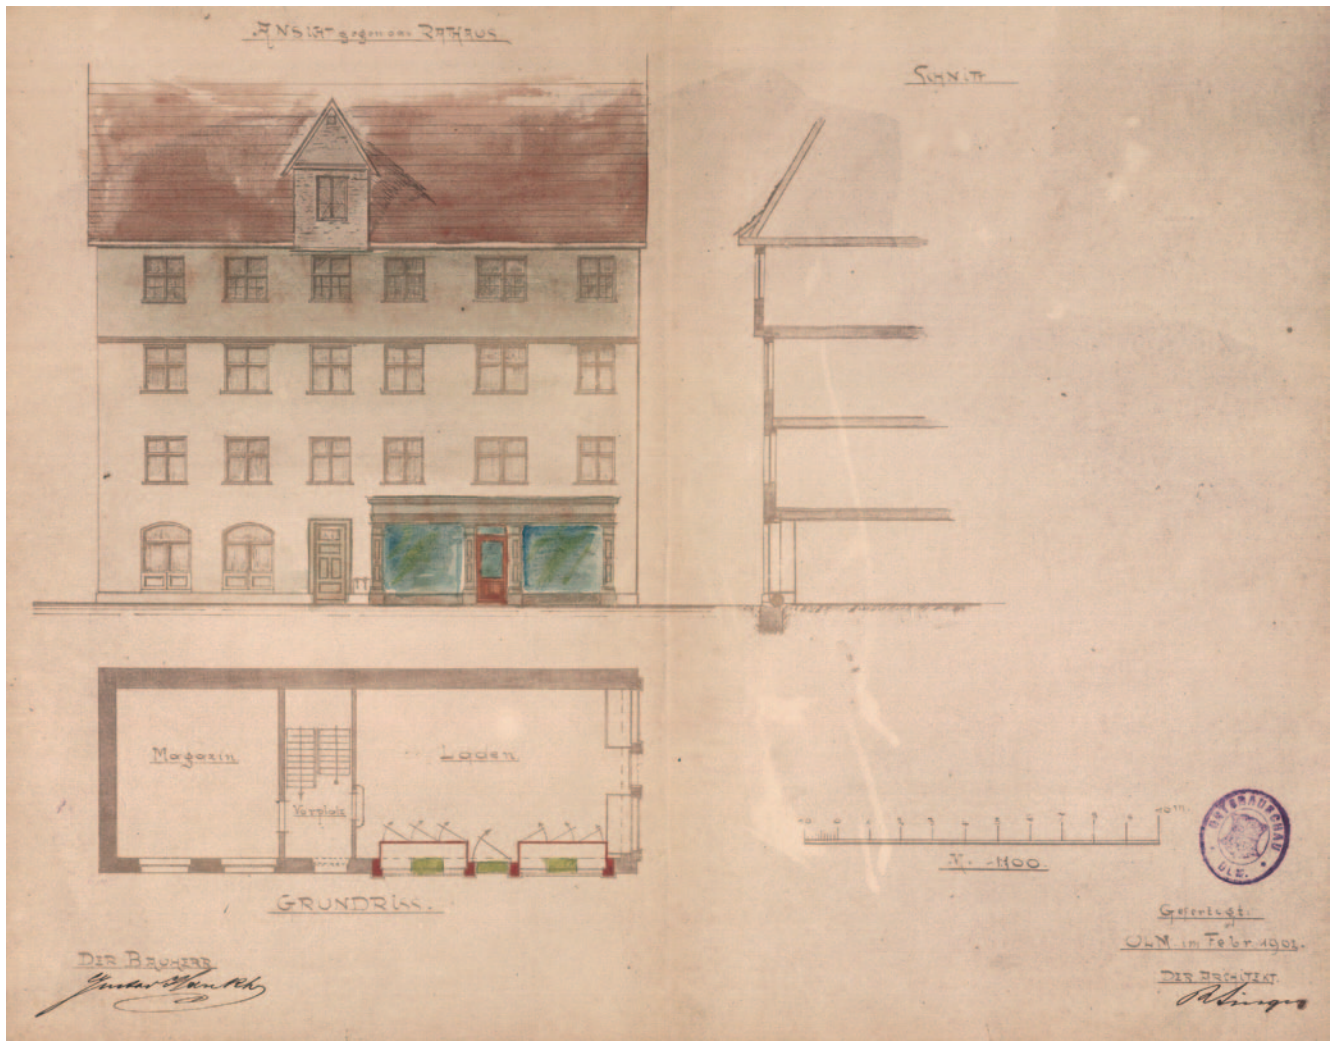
Gebäude Sattlergasse 21 (A 342), Ansicht, Schnitt und Erdgeschossgrundriss, Baugesuch des Kaufmanns Gustav Haukh 1902.
